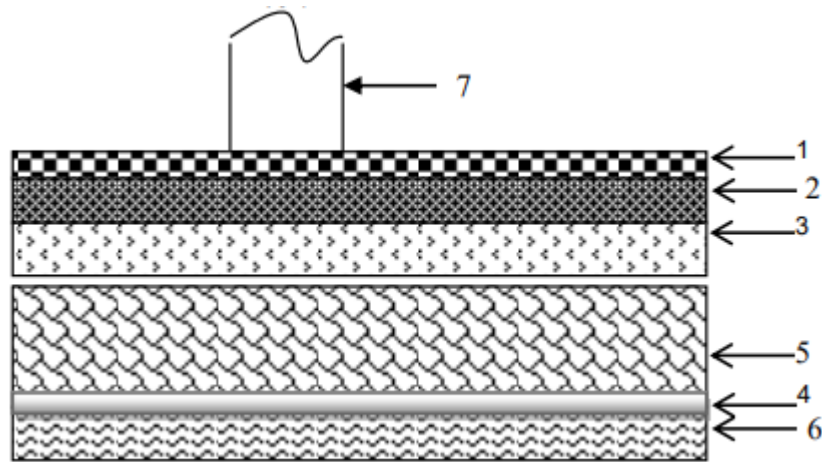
Coupe transversale d'un plancher d'étage courant.
